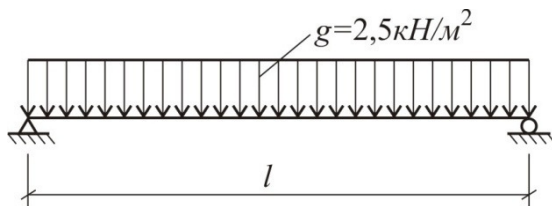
Розрахункова схема балки до прикладу 2.7
